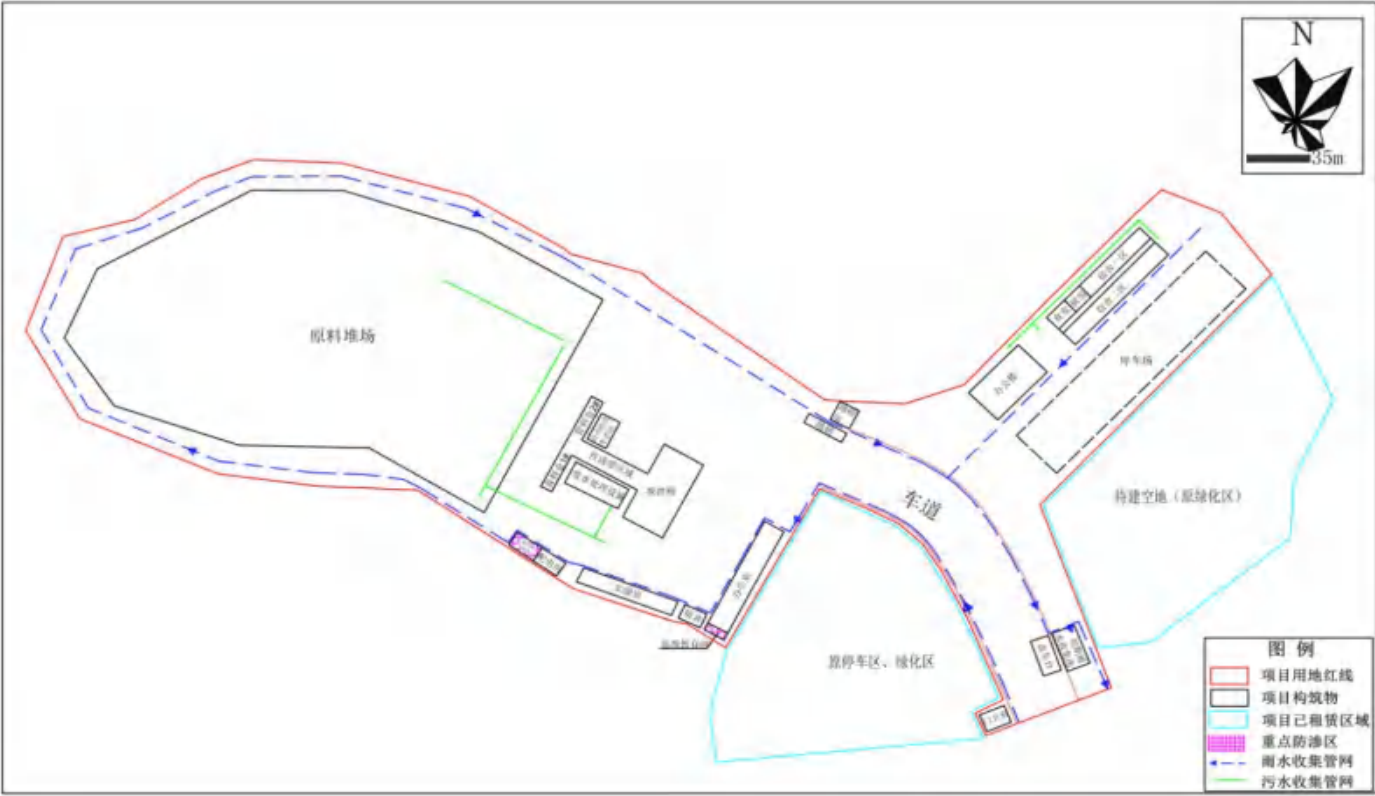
资阳市贝融混凝土搅拌站平面布局图
